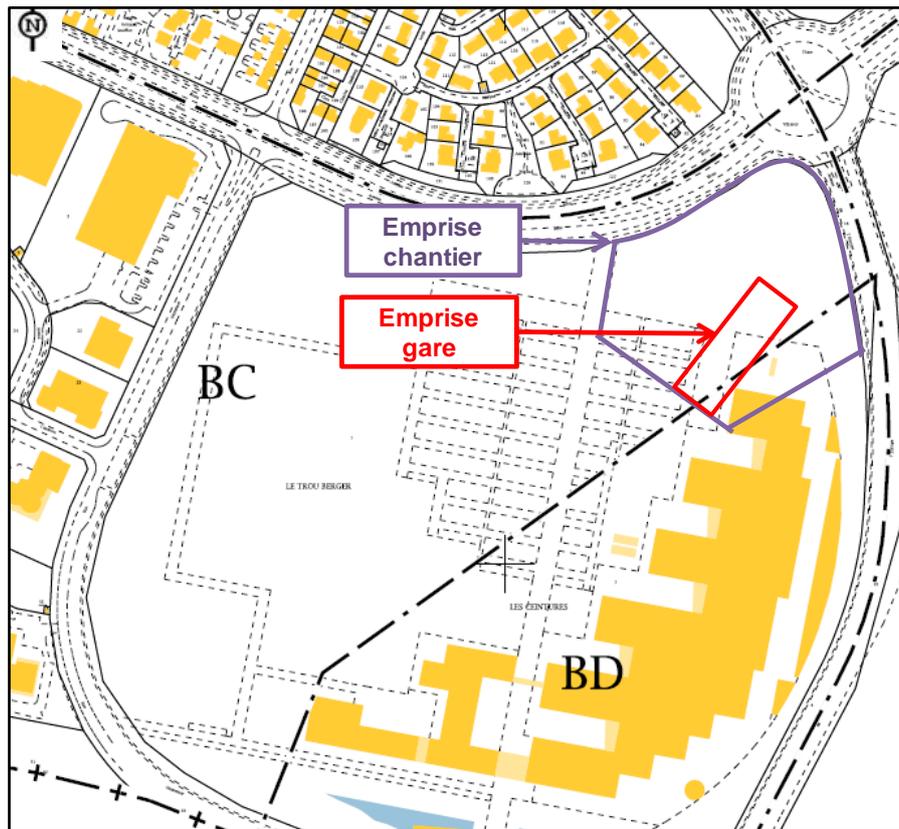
Localisation de la gare de Saint Quentin Est (53SQE) sur fond de plan cadastral (cadastre.gouv.fr)
